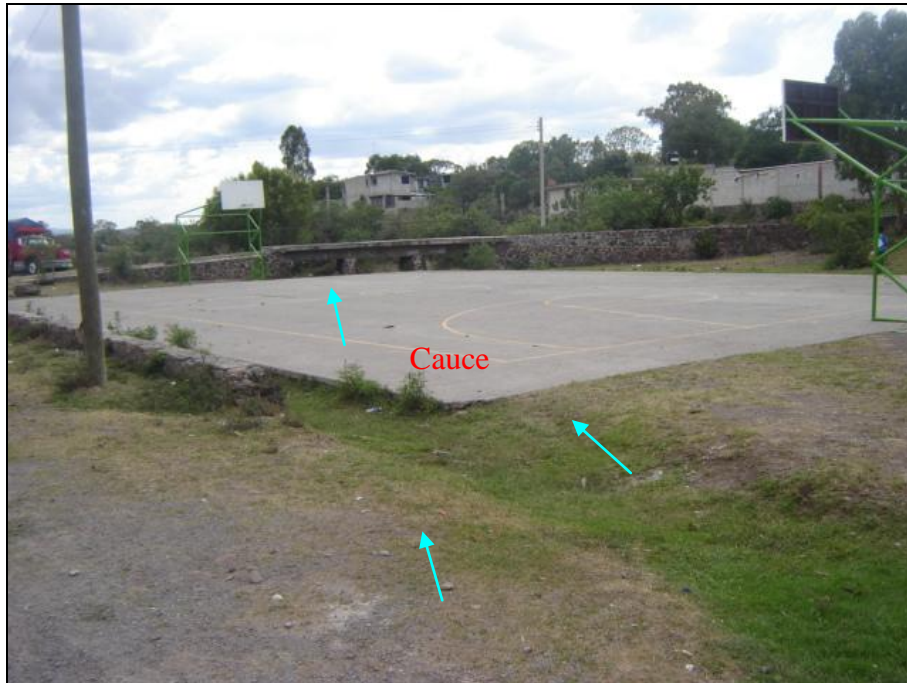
Vista de la infraestructura existente en la zona de paso del escurrimiento.
